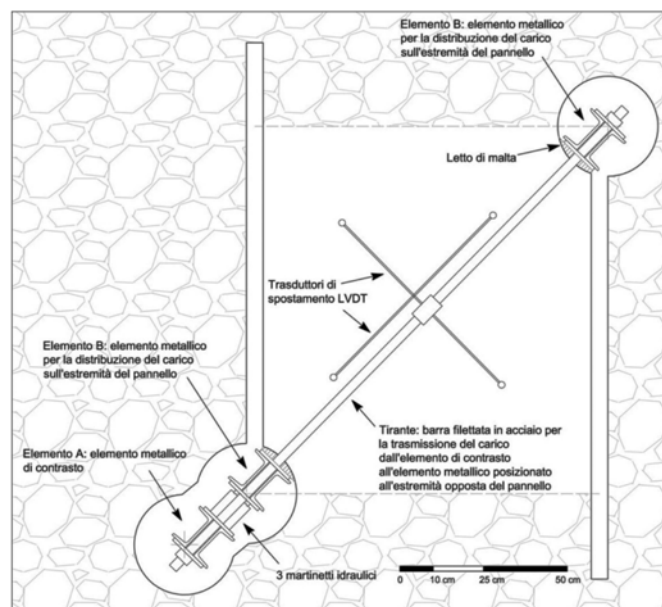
Apparato di prova di compressione diagonale (Dalla Benetta, 2010)
